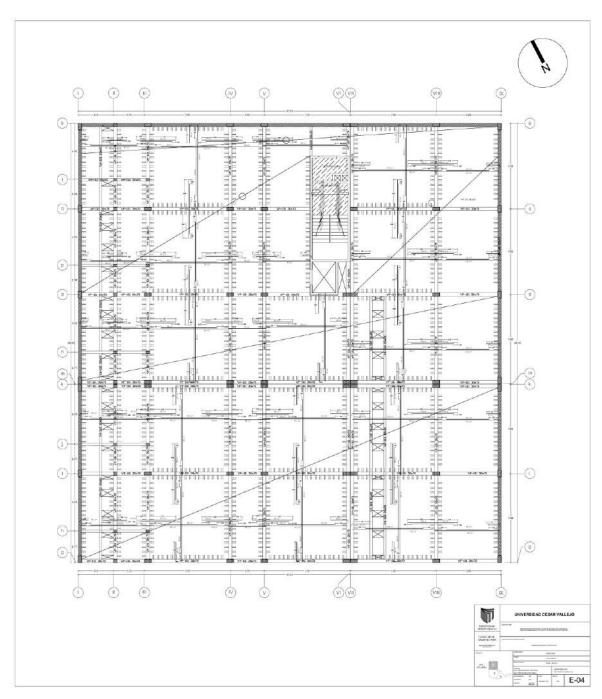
Aligerado - Sótano sector C - ESTRUCTURAS
